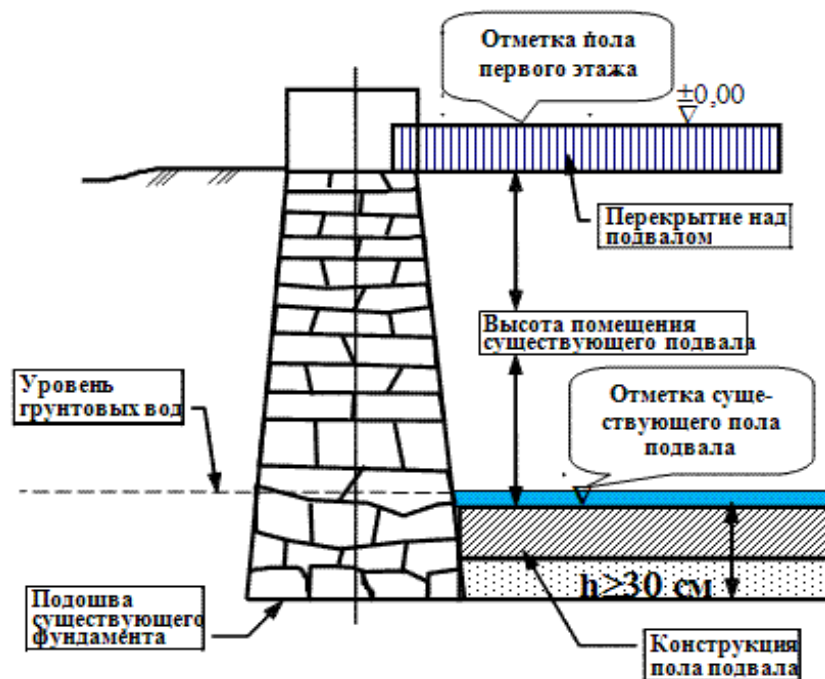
Типичный конструктивный разрез фундамента с подвальным помещением и разрушенной гидроизоляцией при высоком уровне грунтовых вод (У.Г.В.)
